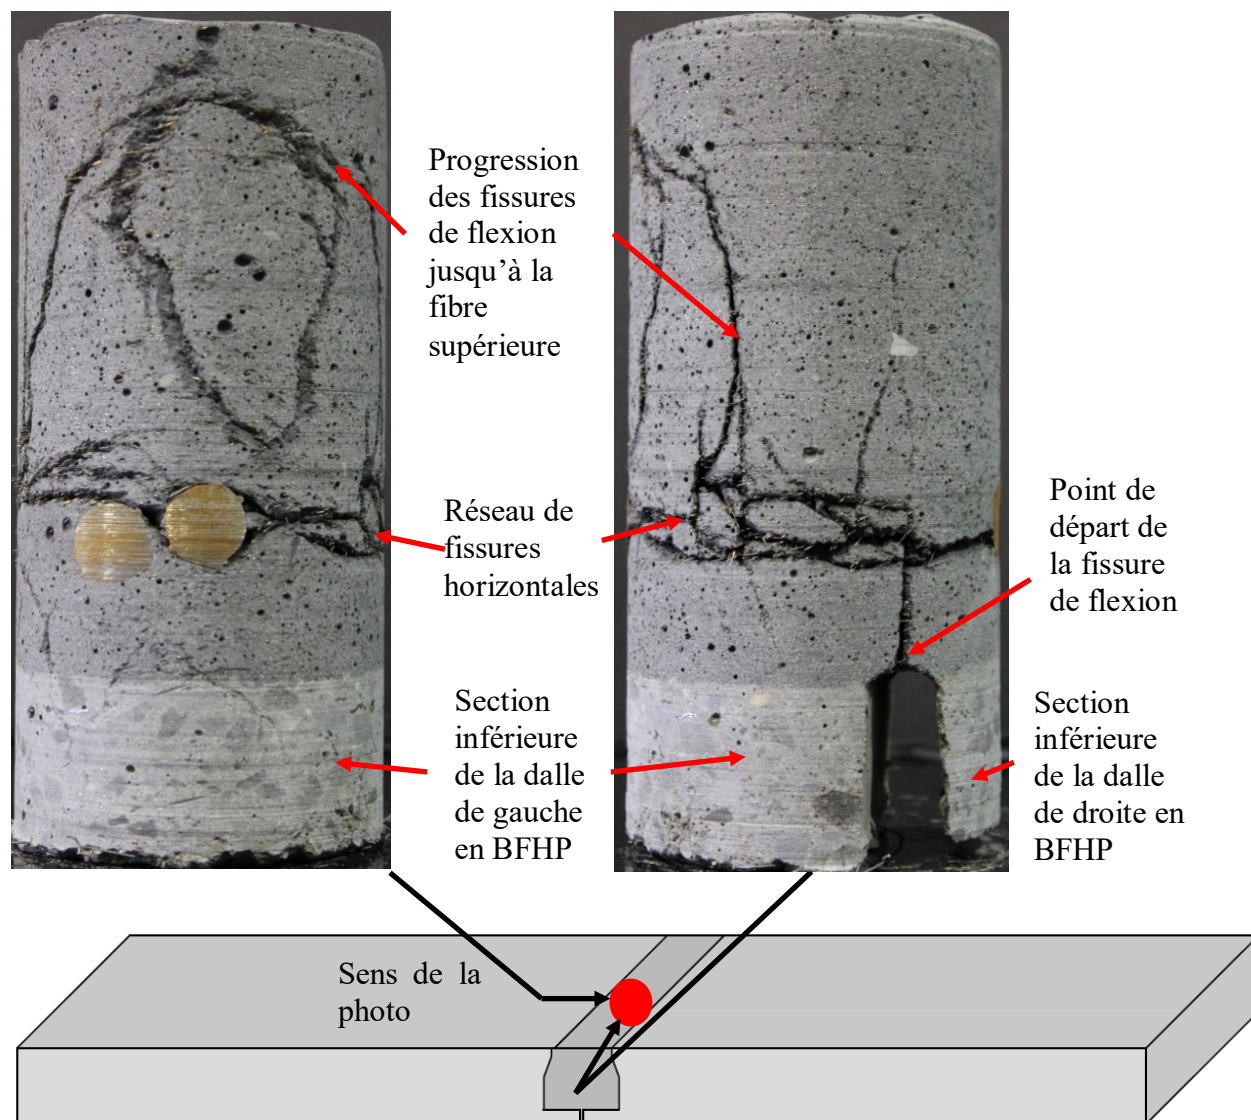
Carottage de la dalle en BFHP avec joint de connexion longitudinal de 200 mm
